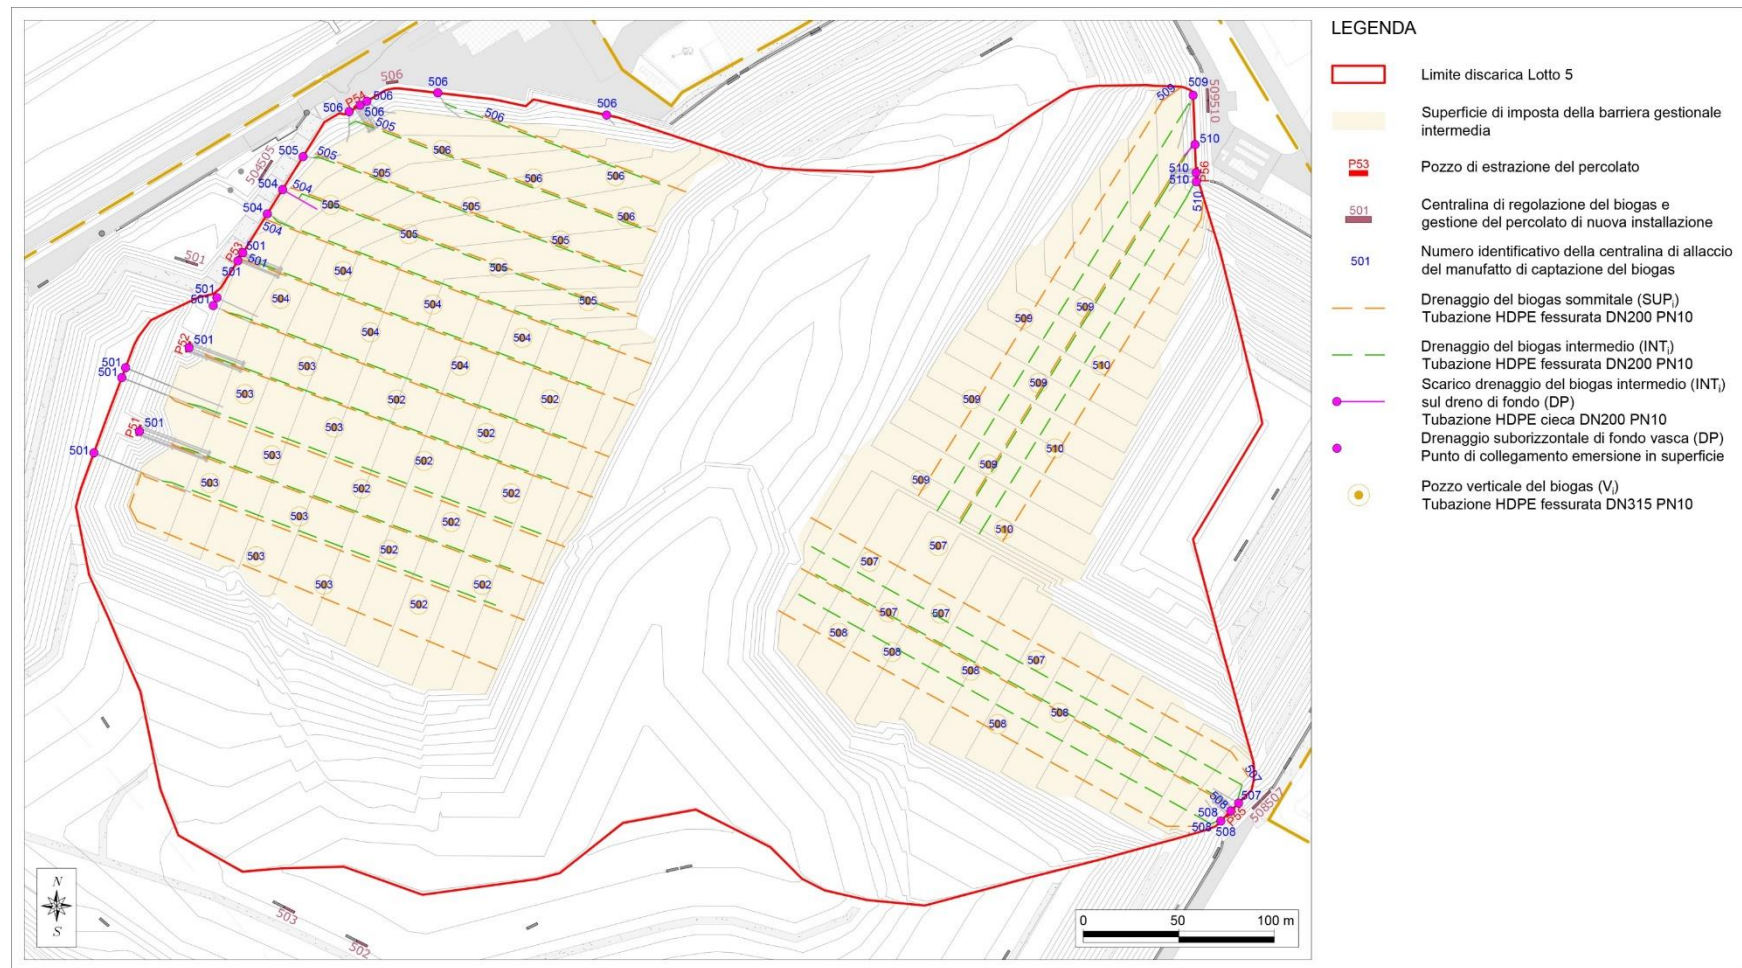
10 – Planimetria con disposizione dei manufatti di captazione del biogas dei moduli inferiori
